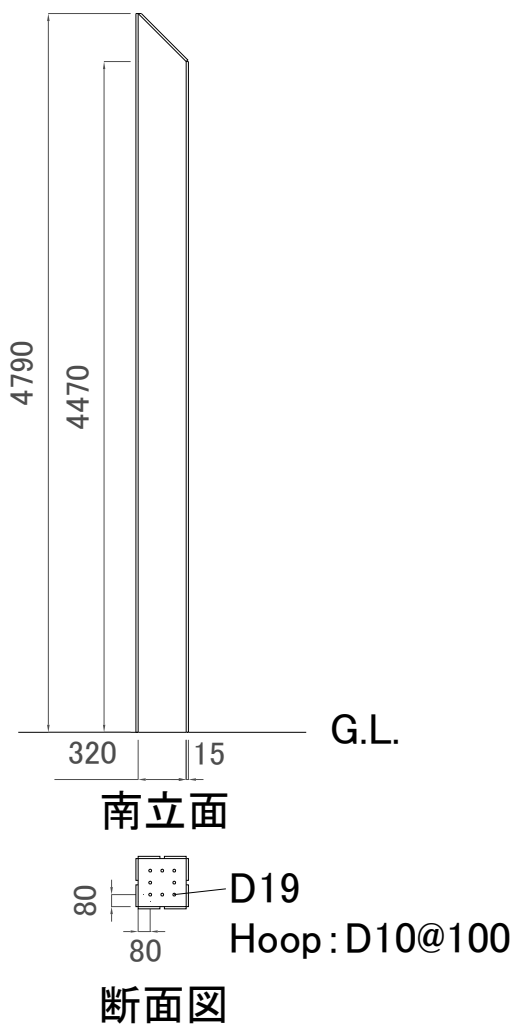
RC 柱時計台の立面図・断面図 (単位: mm)
